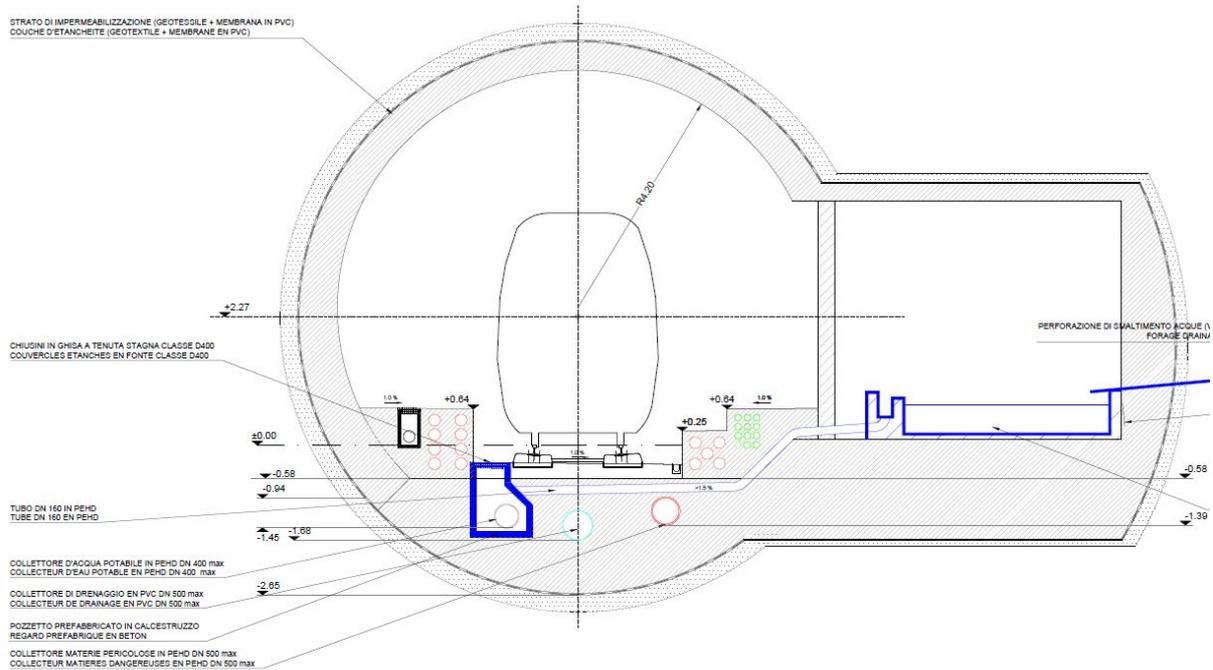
Sistema di captazione delle acque calde potenzialmente potabili. Sezione longitudinale della nicchia
